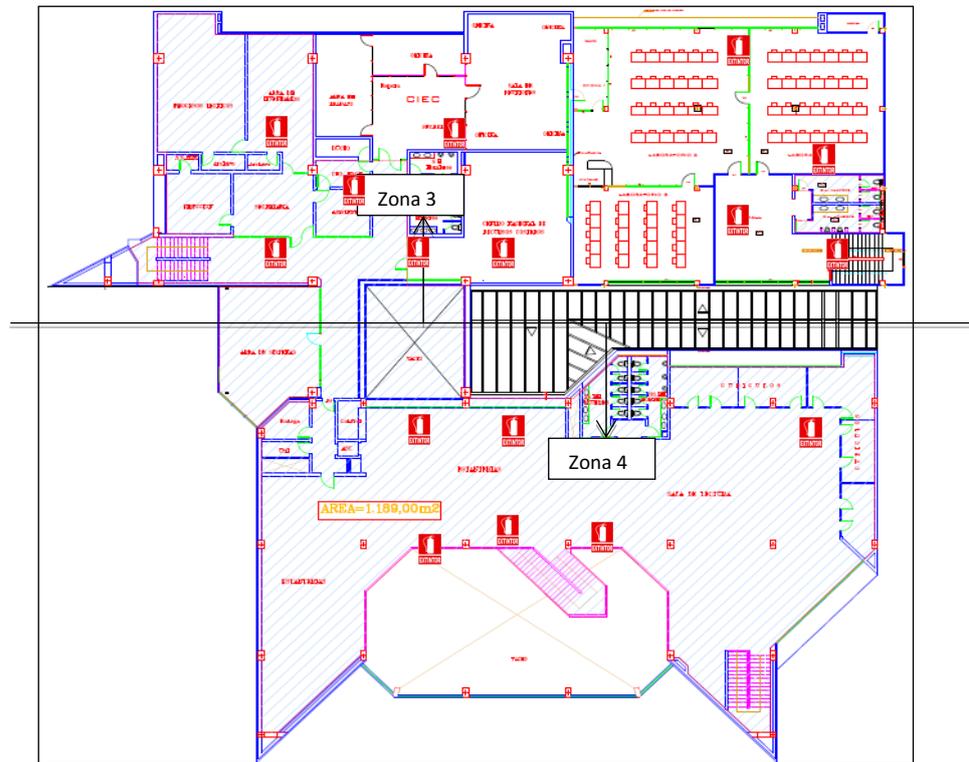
Extintores, Planta Alta, Zona 3 y 4
